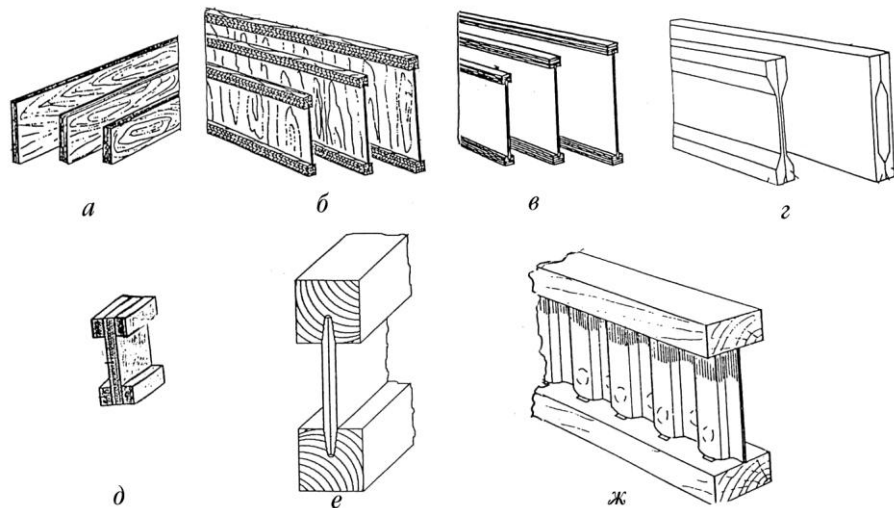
Балки из древесных композитов: *а* – прямоугольного сечения, склеенные из продольно уложенного шпона (Microllam); *б* – двутавры с поясами из композита Microllam и фанерной стенкой; *в* – двутавры с поясами из композита Parallam и фанерной стенкой; *г* – древесностружечные прессованные балки; *д* – двутавры с поясами и стенкой из плит Microllam; *е* – двутавры со стенкой из твердых древесноволокнистых плит; *ж* – двутавры Nail-Web с впрессованной волокнистой стенкой из жести
